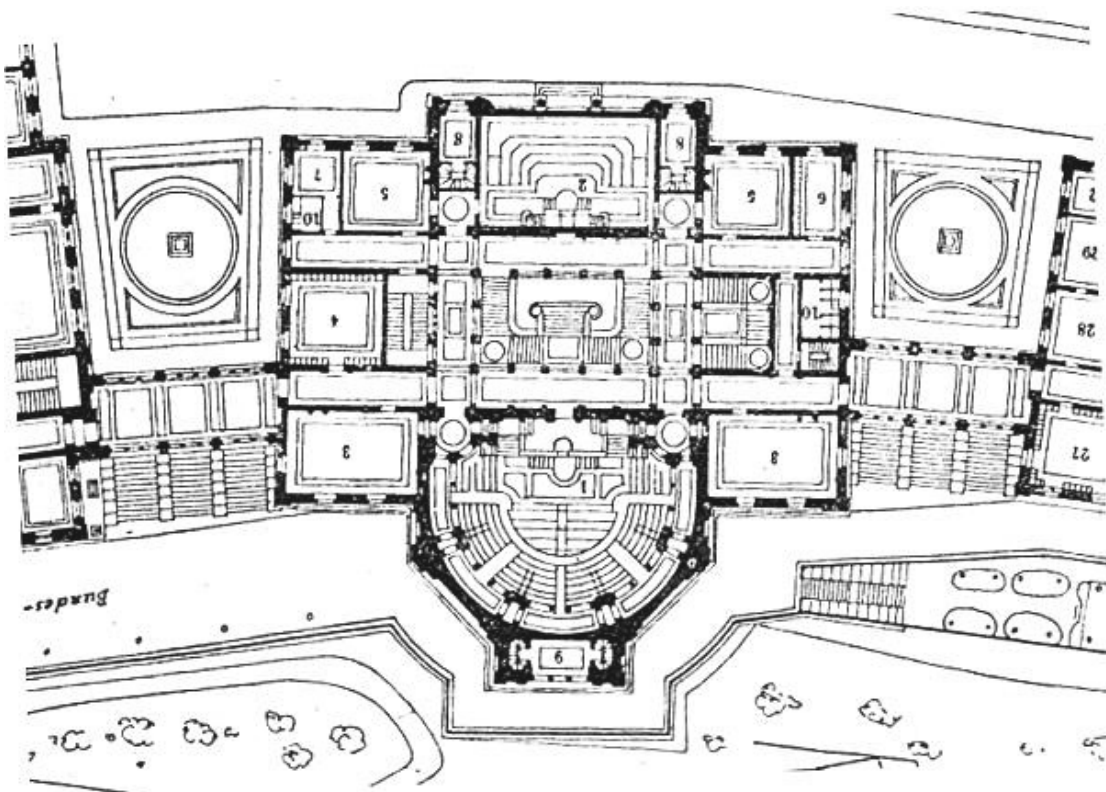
Grundriss Hauptgeschoss, Girardet/Bezencenet.
